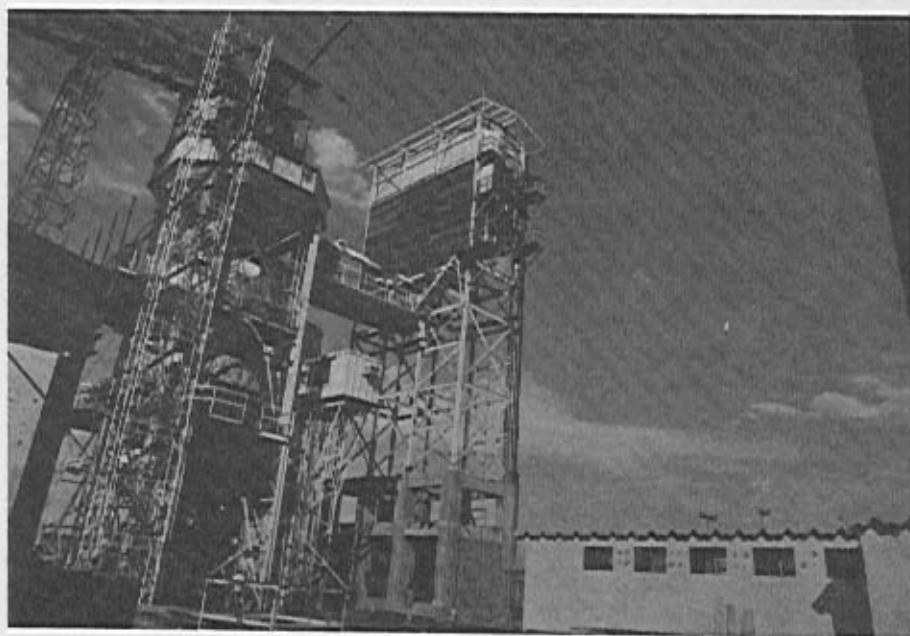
Estrutura Metálica para Fábrica de Gelo. Na parte Superior a sala para Máquinas de Gelo e à Esquerda a Central de Concreto – UHE – Cachoeira Dourada.
